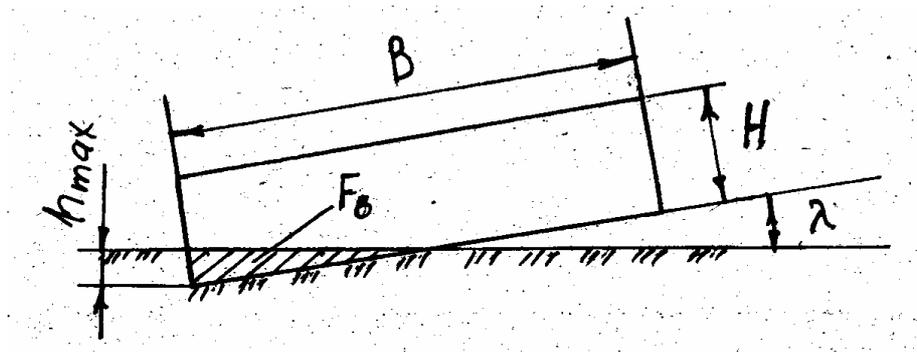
Схема для определения площади вырезаемой стружки грунта:
